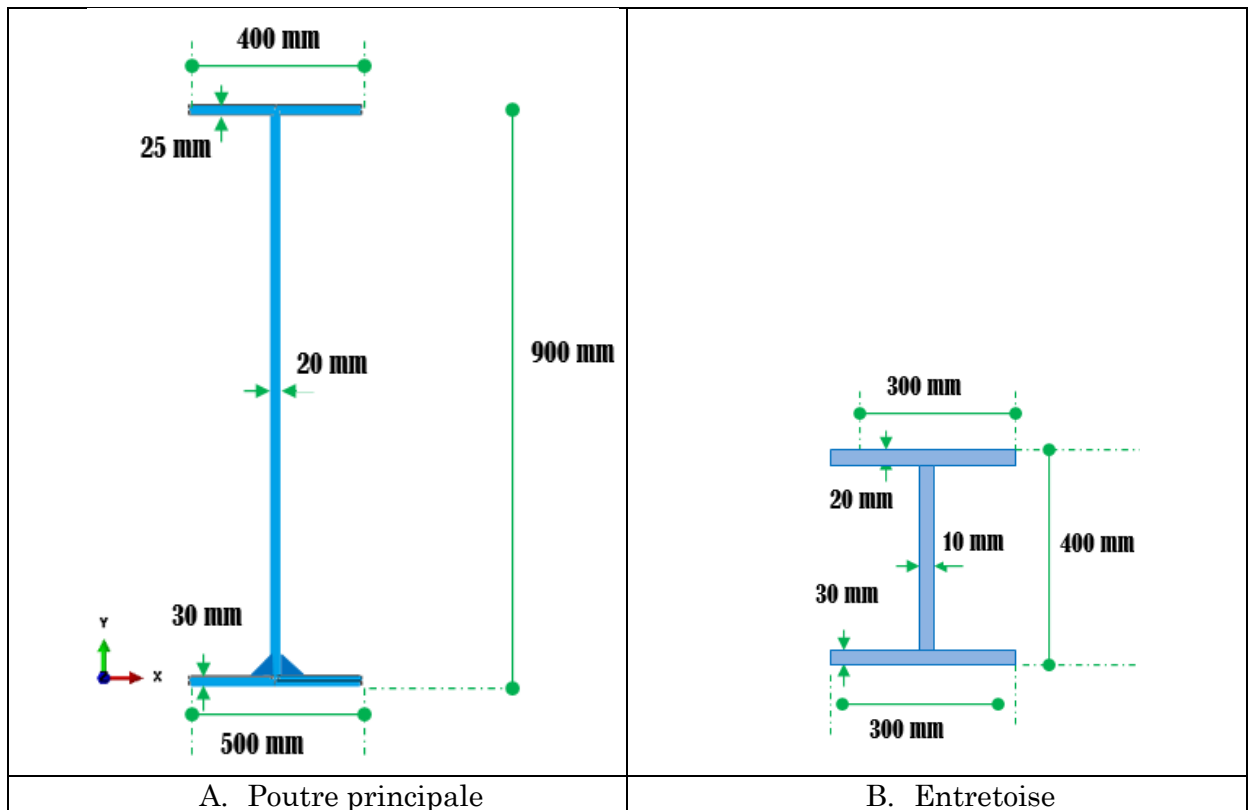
Les dimensions de la poutre principale et l'entretoise
